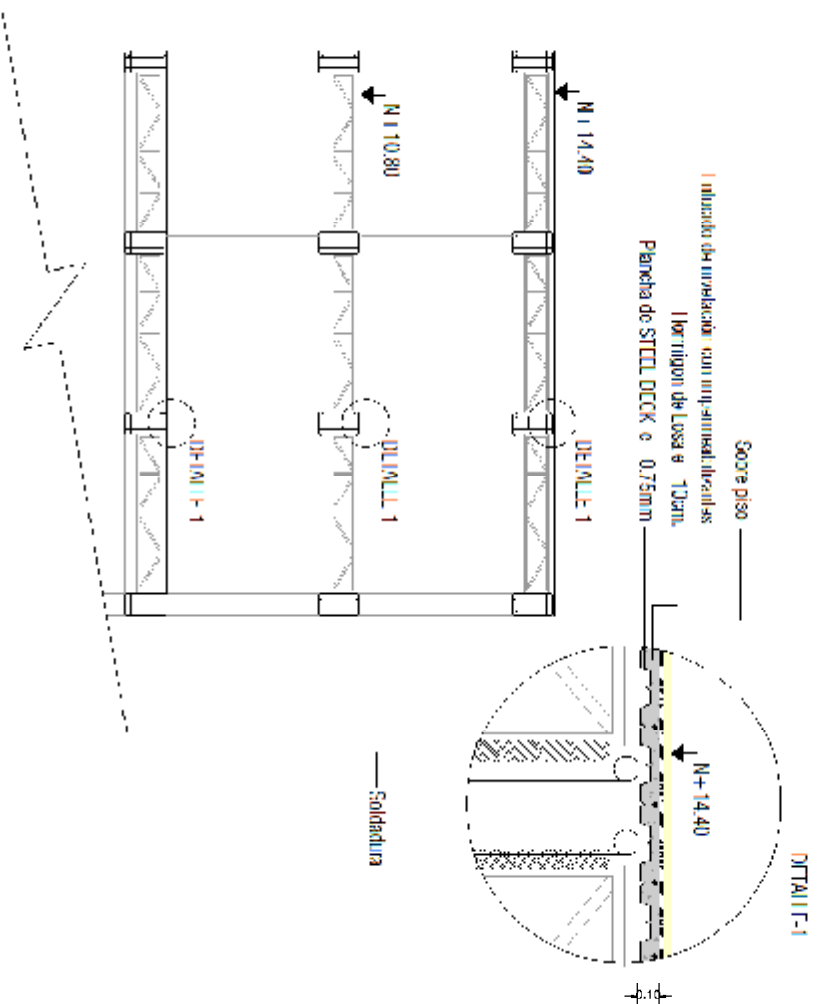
Detalle de losa. Fuente: Jaime Dávila, 2015
